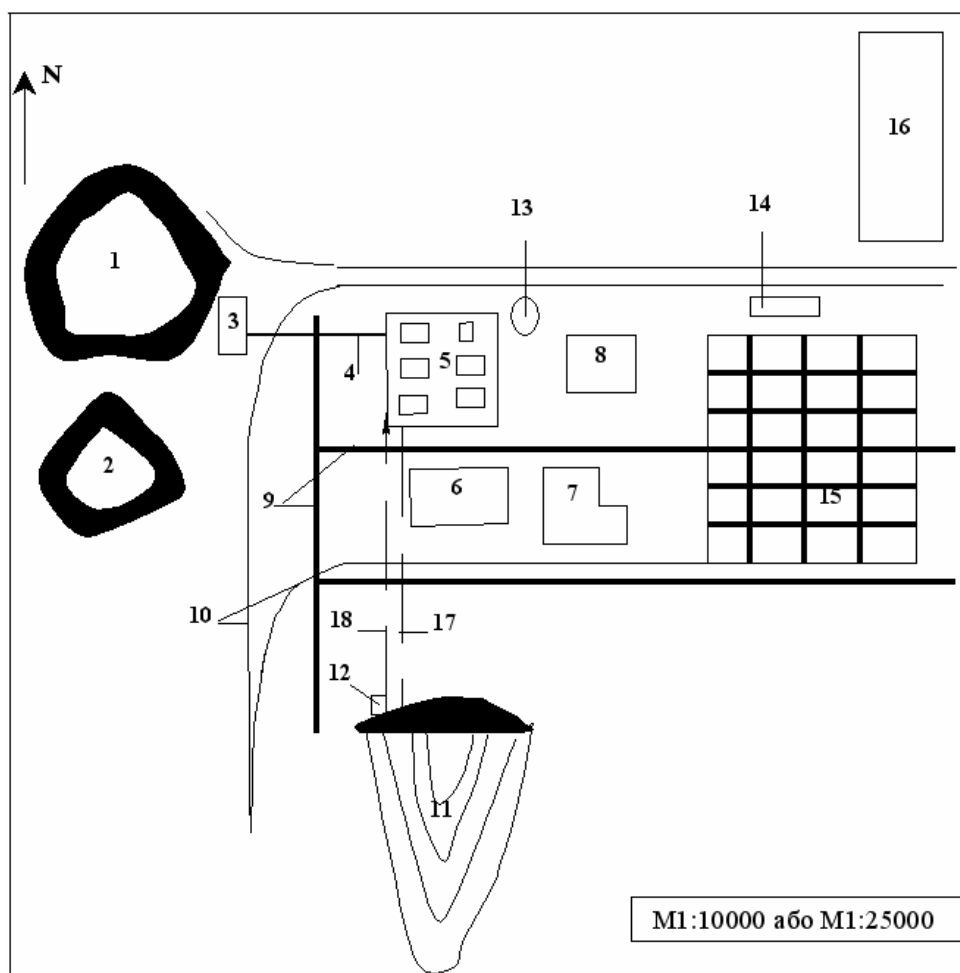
Схема ситуационного плану розміщення збагачувальної фабрики: 1 - кар'єр; 2 - відвал пустої породи; 3 - корпус крупного дроблення; 4 - галерея стрічкового конвеєра; 5 - збагачувальна фабрика; 6 - ТЕС; 7 - ремонтно-механічний завод; 8 - електропідстанція; 9 - автодороги; 10 - залізниця; 11 - басейн-сховище дрібних відходів; 12 - насосна станція оворотної води; 13 - залізнична станція фабрики; 14 - залізнична станція МП; 15 - місто; 16 - завод-переробник; 17 - пульпопровід; 18 - водовід оворотної води.
